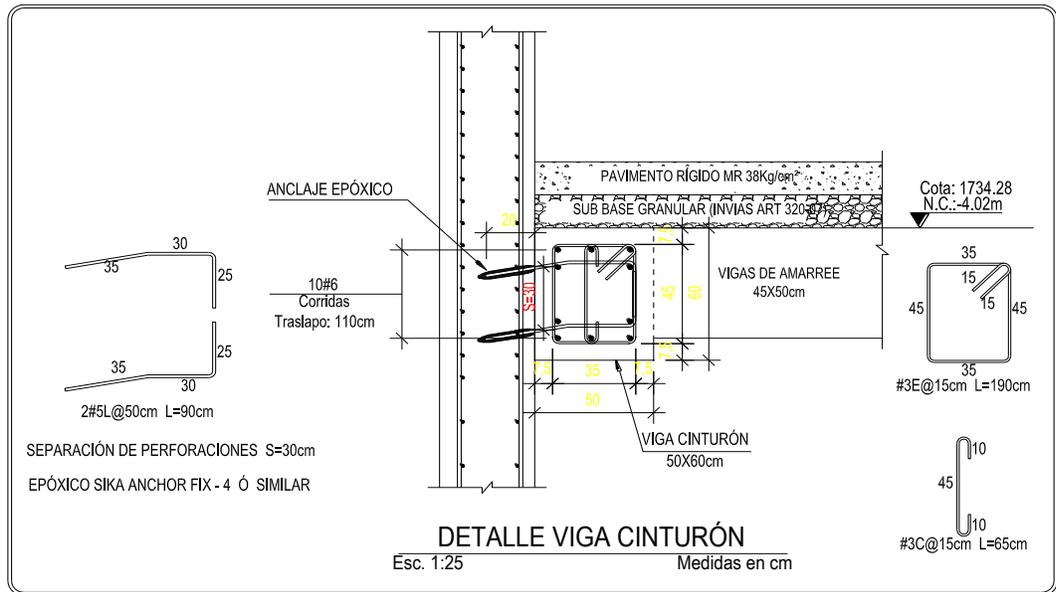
Diseño viga cinturón (Fuente: Departamento de diseño Metálicas e Ingeniería S.A.)
